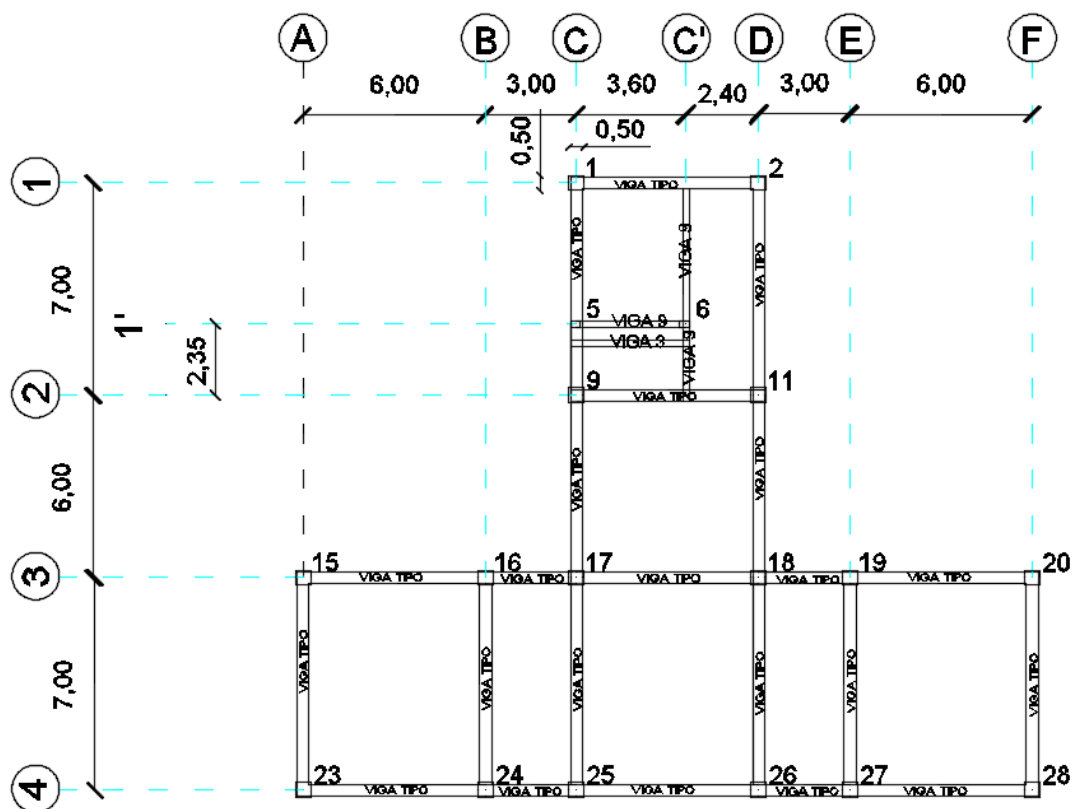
, Esquema de plano de vigas, edificio BNC CENTRAL, Jipijapa, Manta.
